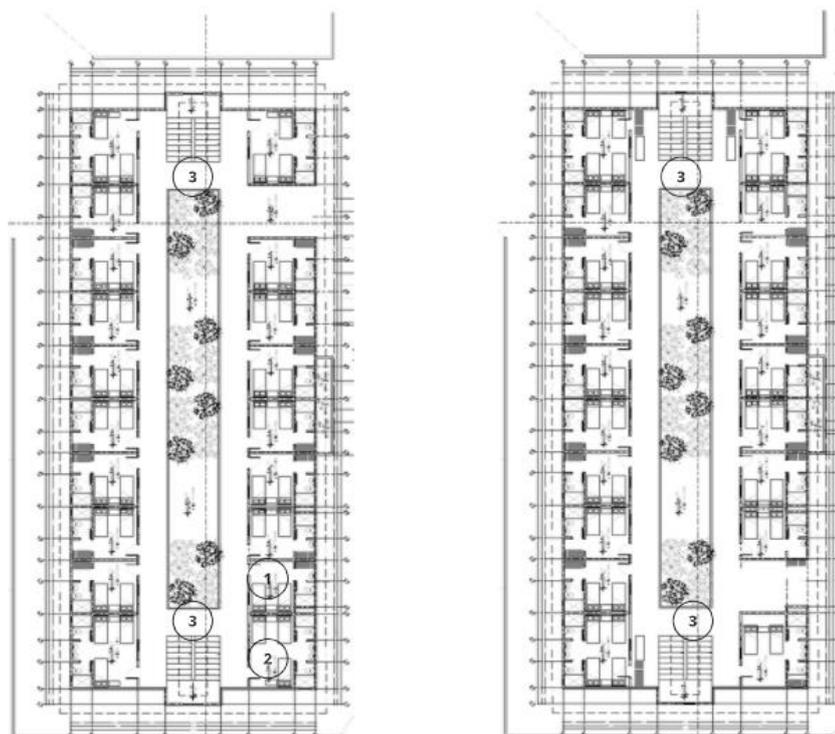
Plantas arquitectónicas de edificio de hospedaje
